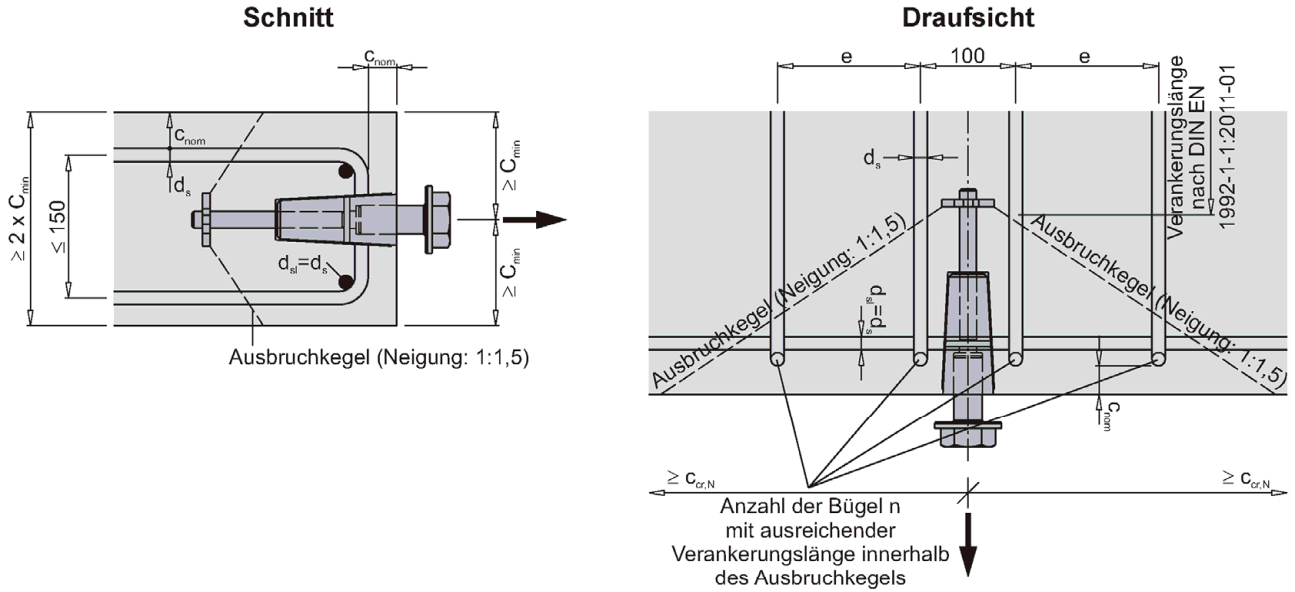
Einbausituation Stirnseite - Zugbeanspruchung mit Rückhängebewehrung - Bewehrungslage
